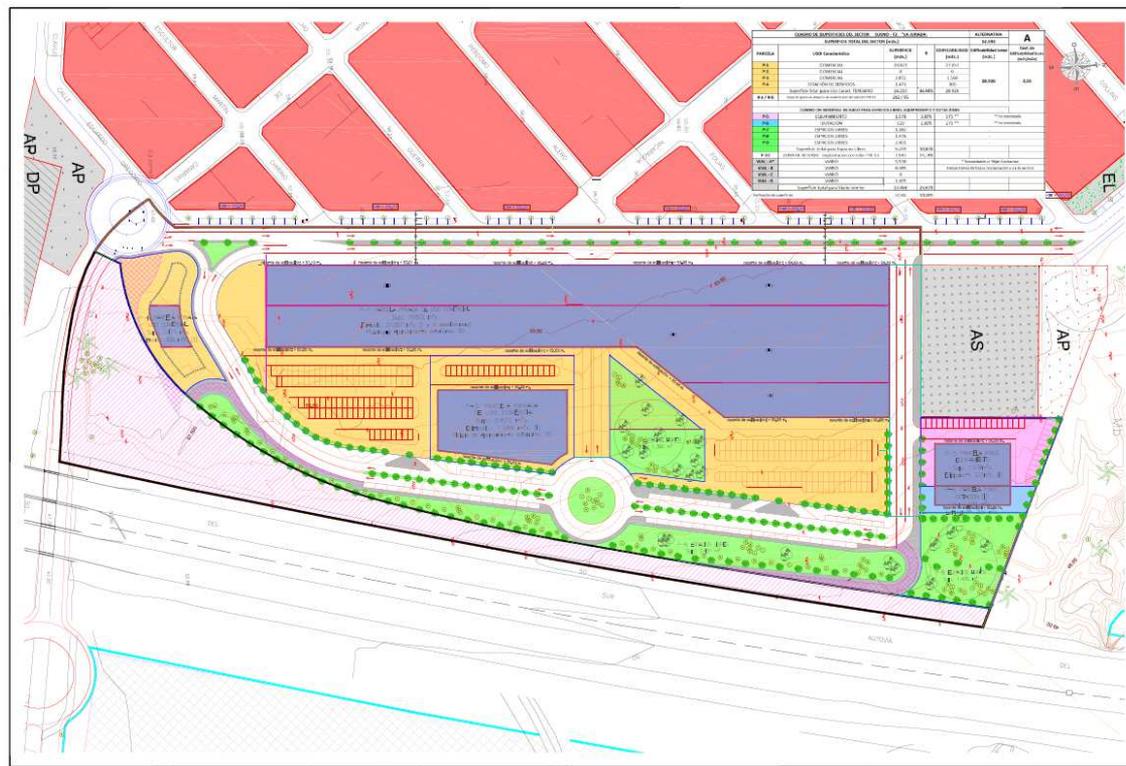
Plano General Alternativa A. Elaboración propia.
